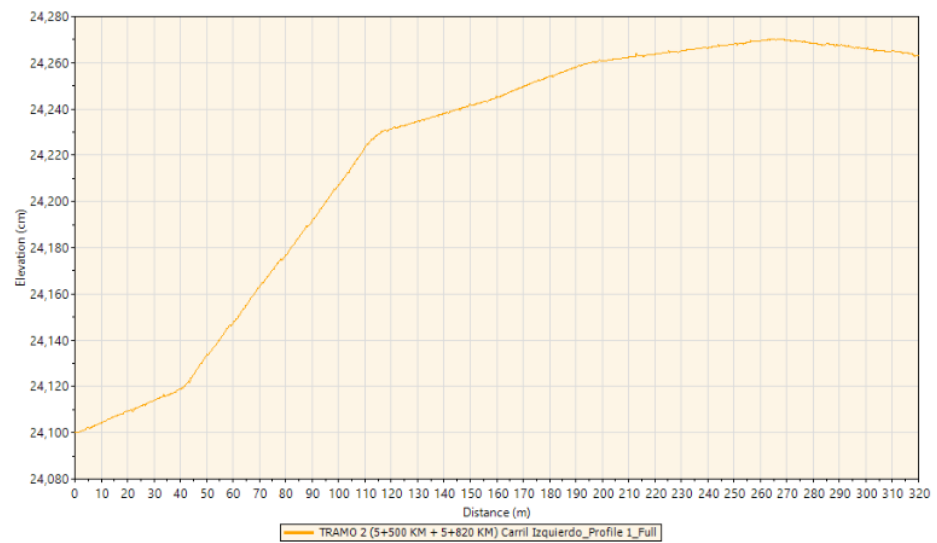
Perfil Longitudinal Tramo 2 (5+500 KM - 5+820 KM) Carril Izquierdo. Fuente: Elaboración propia
